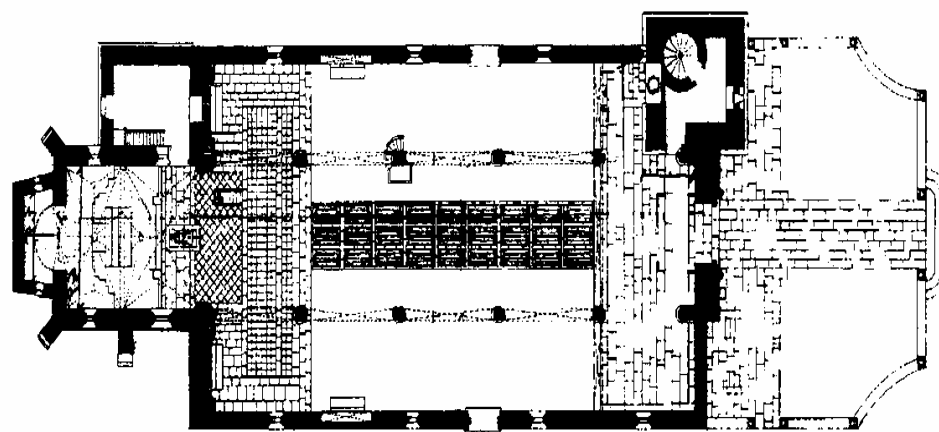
Planta da igreja de Santa Maria de Azurara [3]
